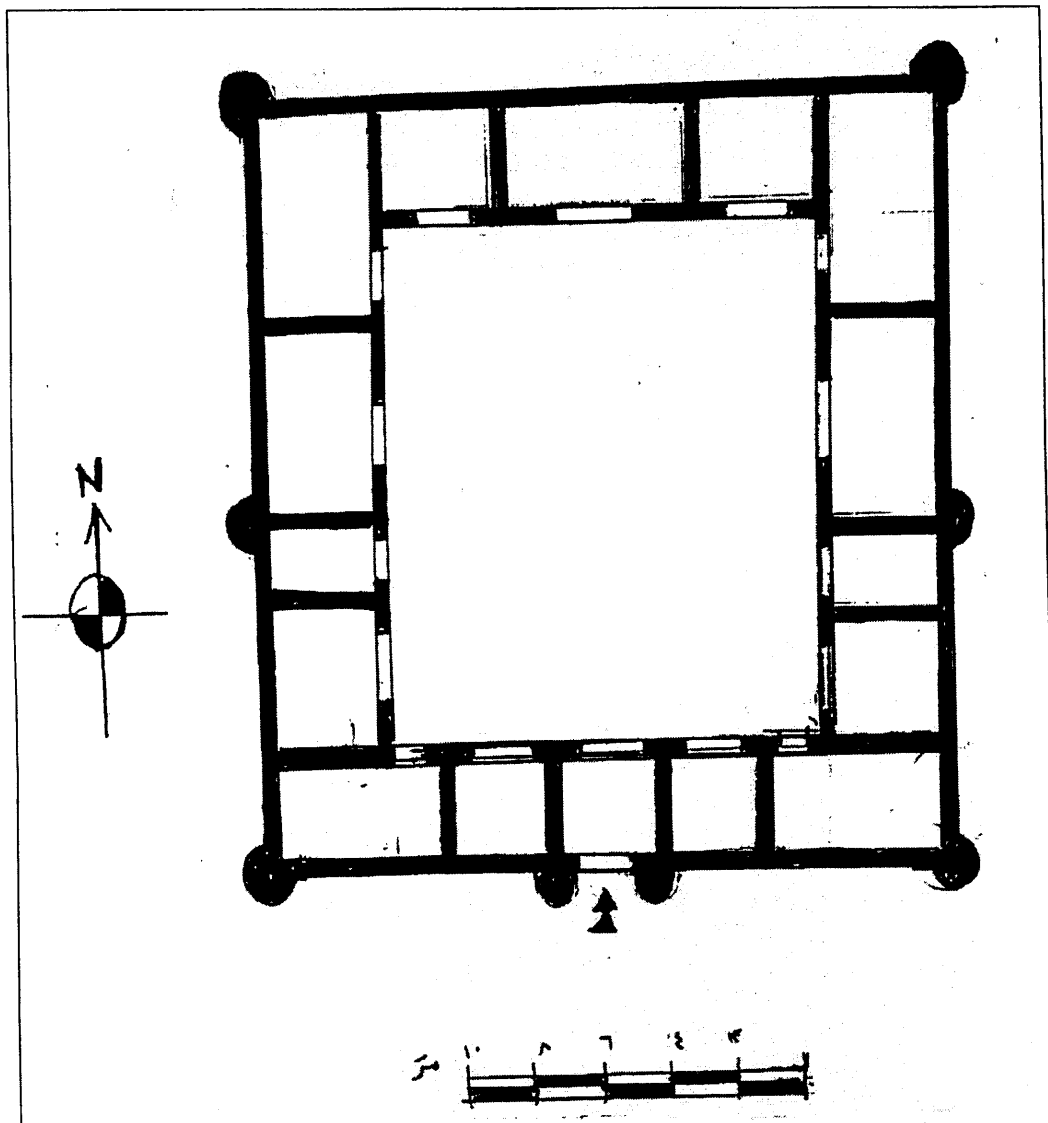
مسقط أفقي لبقايا المبنى السكني (ج). بمدينة الجميرا
